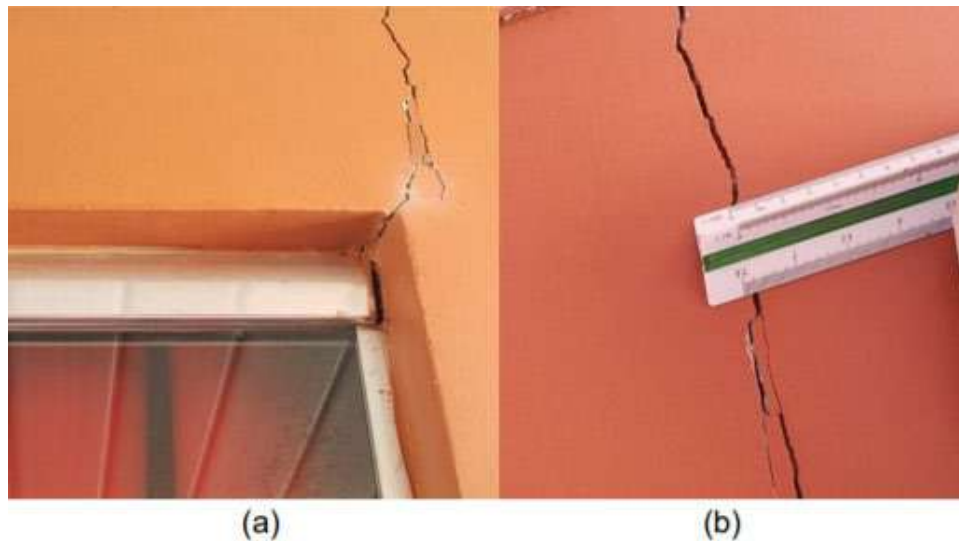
Fissuração em parede de alvenaria na região dos pontos de fixação de janelas
